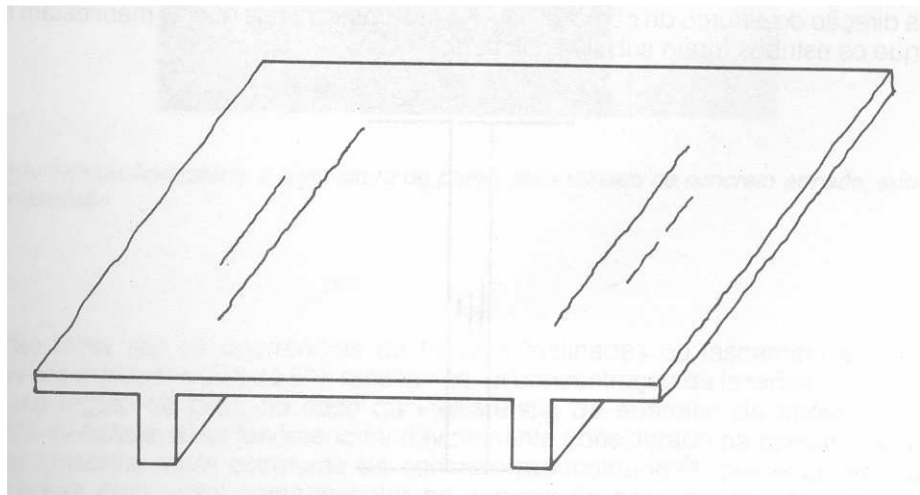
Trincas na face superior da laje devidas à ausência de armadura negativa.
